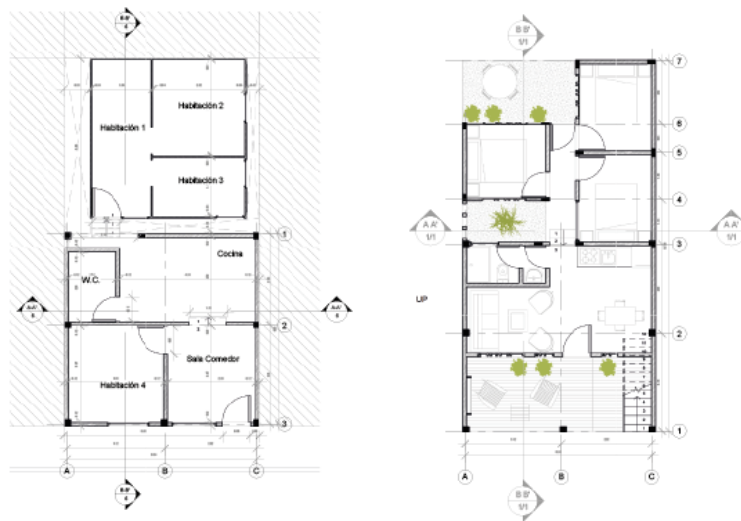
Mejoramiento primer piso vivienda 180 (mampostería confinada)
